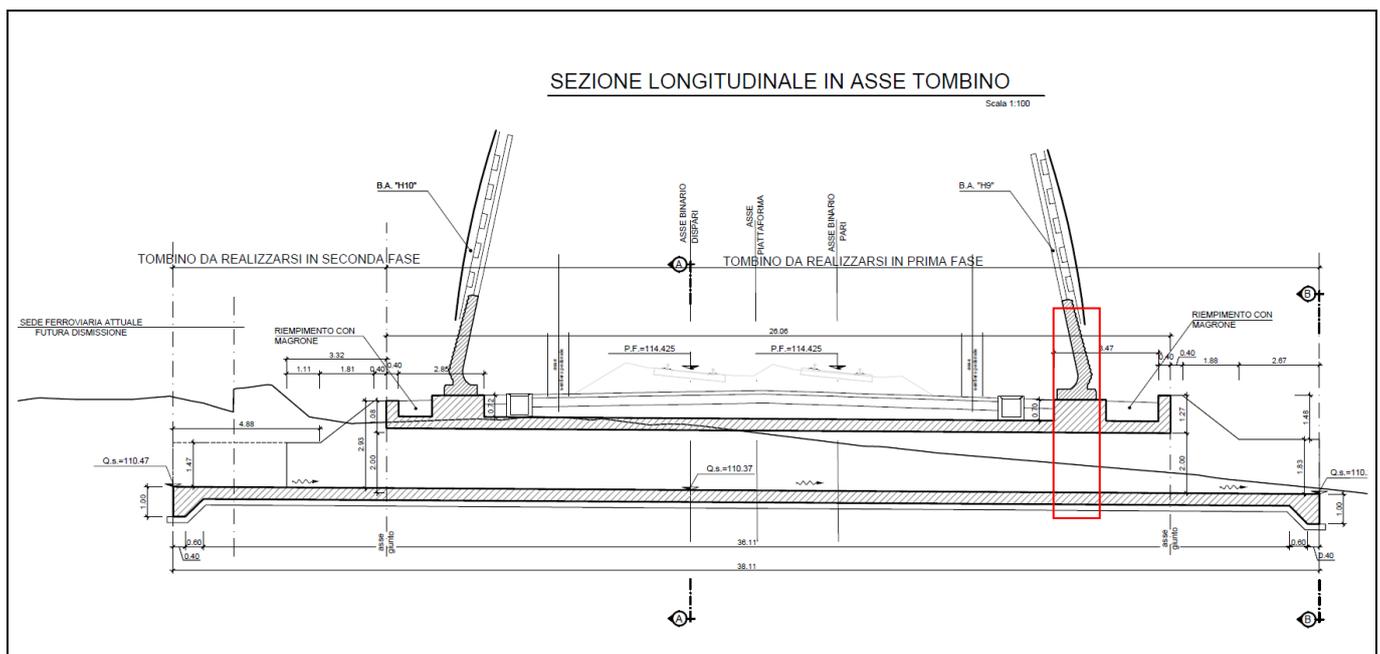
Sezione longitudinale e individuazione delle sezioni SC2 oggetto di verifica.
